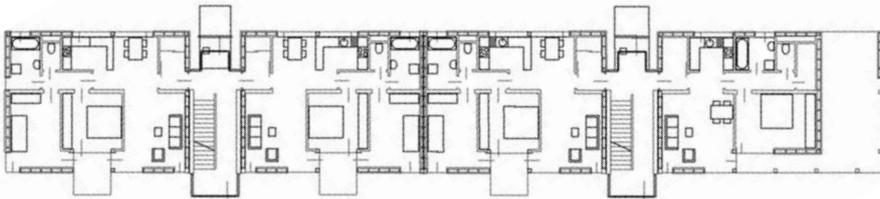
Grundriss Wohnbau Klagenfurt
